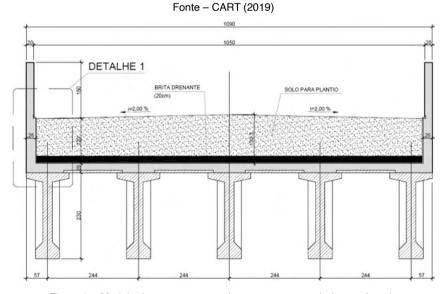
Modelo da superestrutura de uma passagem de fauna elevada Fonte – CART (2019)
